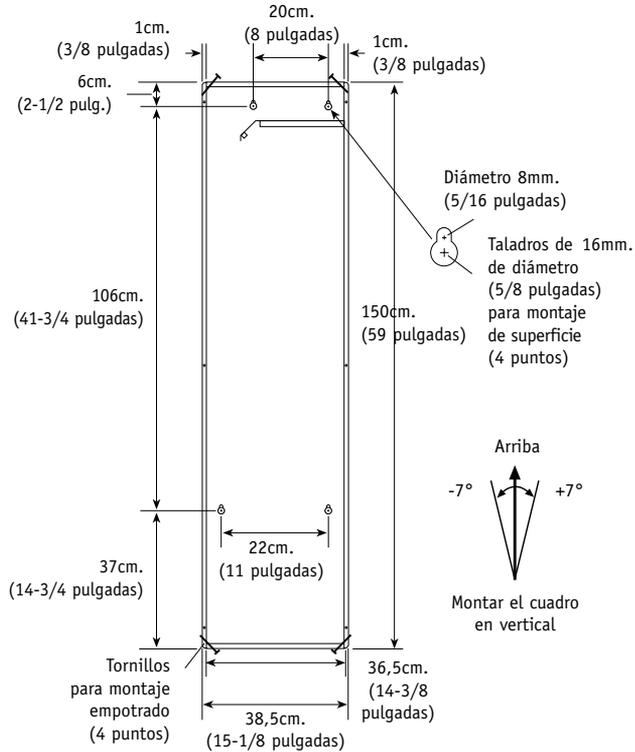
dimensiones del cuadro HW-PNL-8-CE
